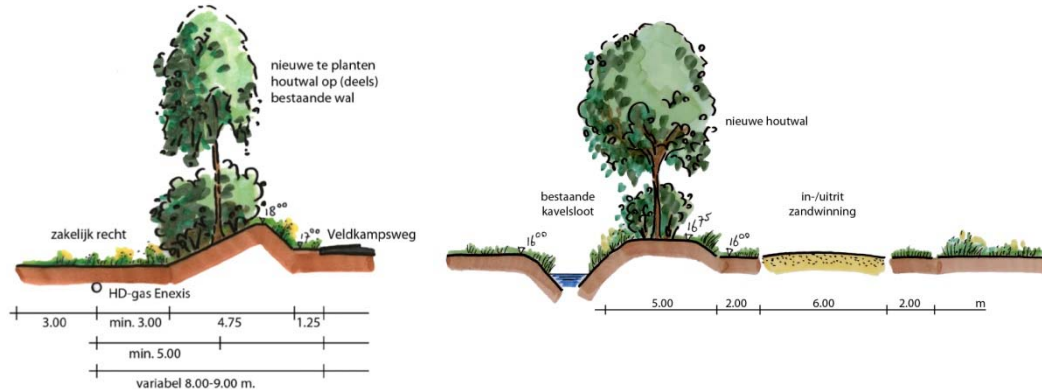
Ontwerp voor Fase I alternatief Poelkampen
